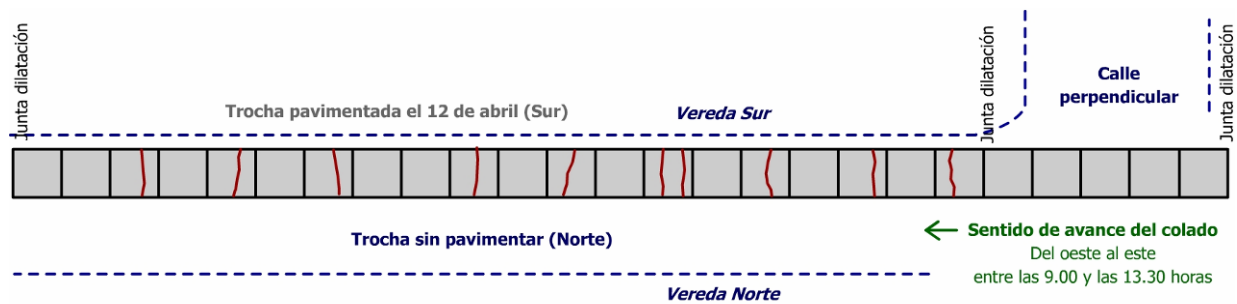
Caso 2 - Patrón de fisuras para losas de pavimento.
